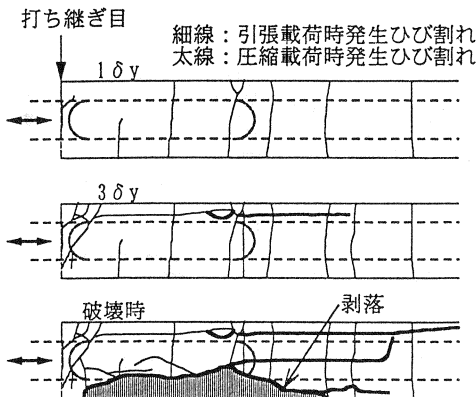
ひび割れ図 (CASE-2 供試体)
